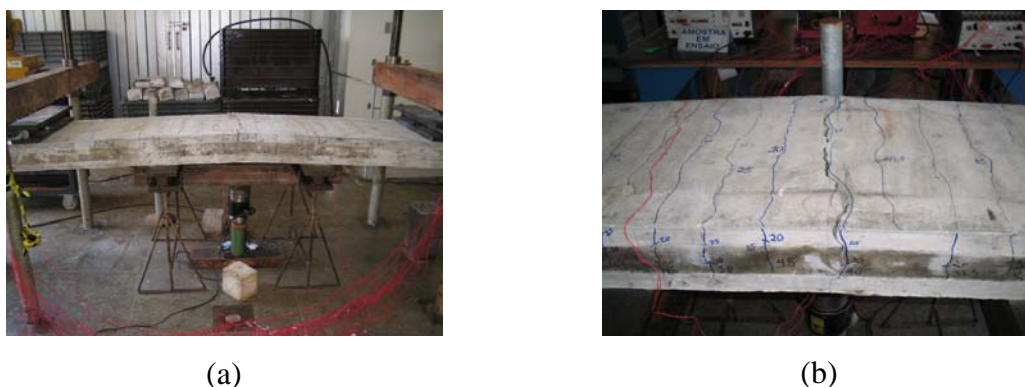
Configuração das fissuras no painel P-2L-PN-45.
